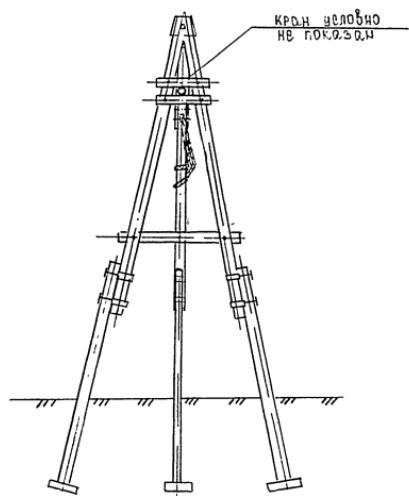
Вариант 1. Демонстрація опоры с пасынками. Укладка А-образной фермы на землю.
